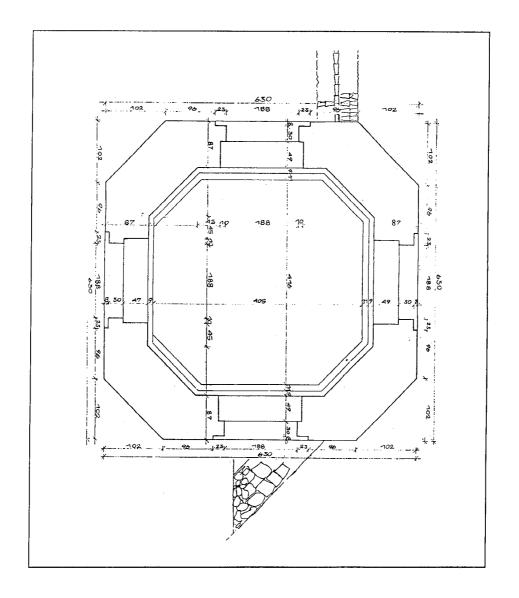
مسقط أفقي لتربة خسرو باشا بإستانبول (عن :عبد الحافظ) .
